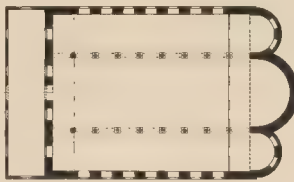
Kirche des heil. Demetrius. Grundriß.
